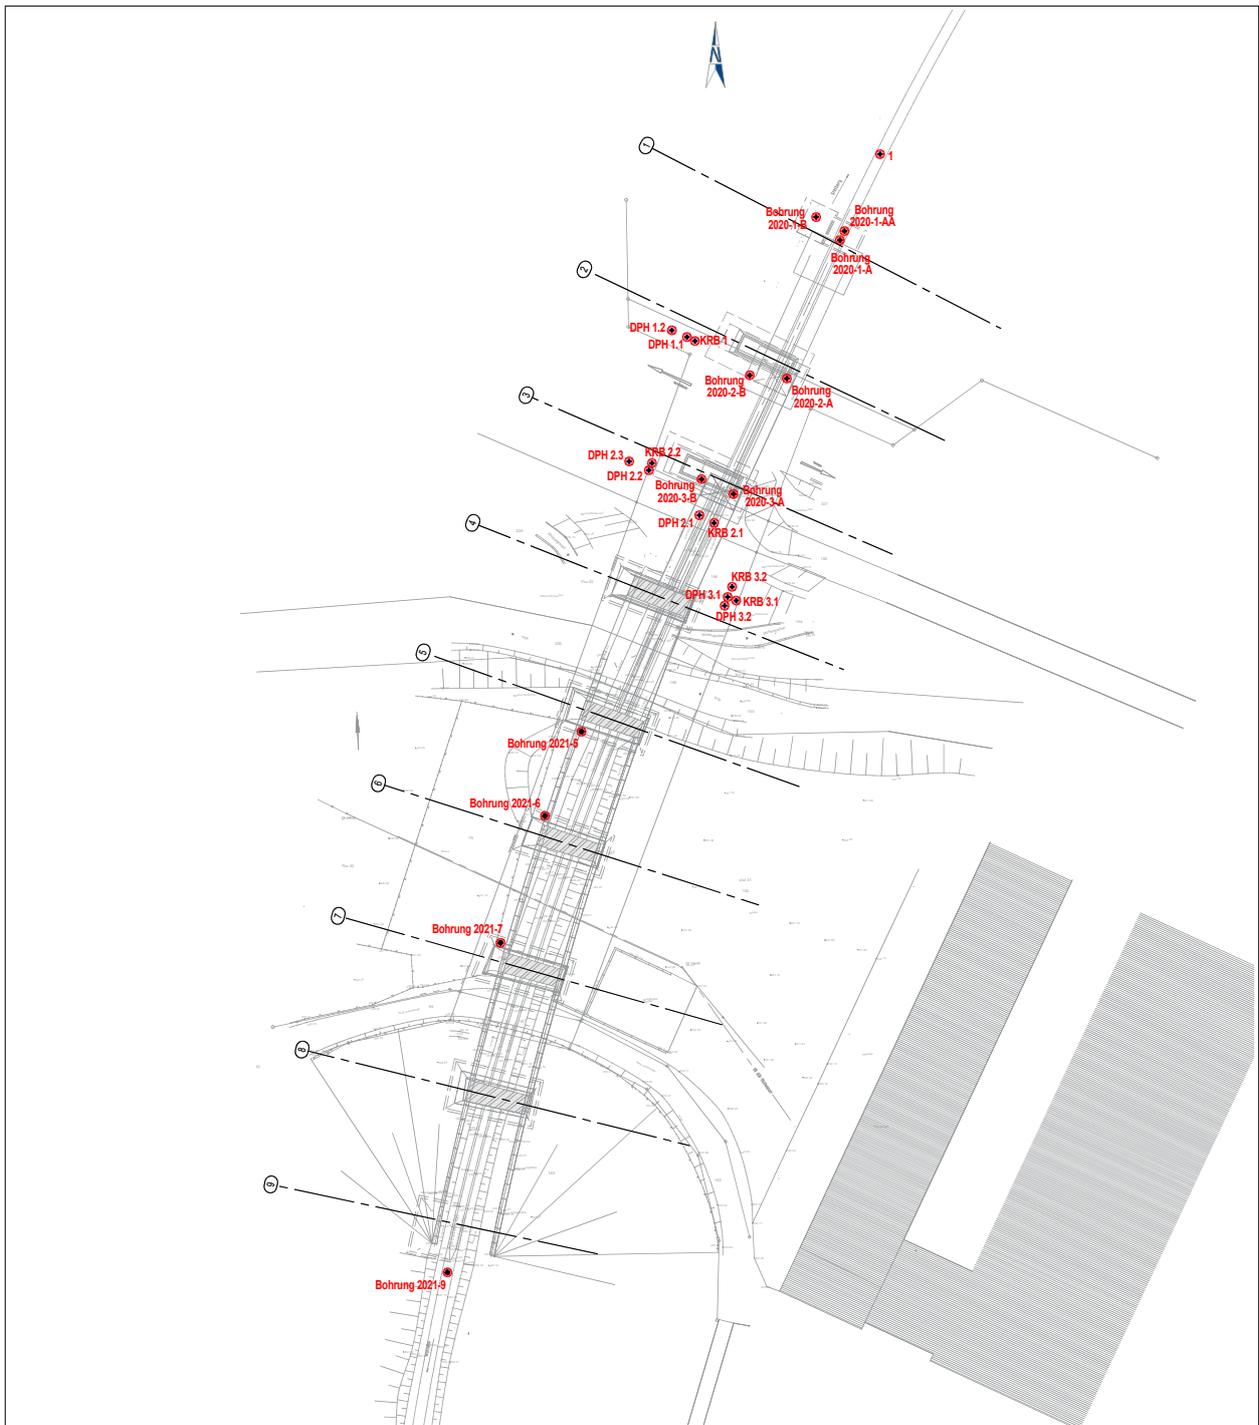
Lageplan Baugrunderkundungen, Maßstab 1:1000
